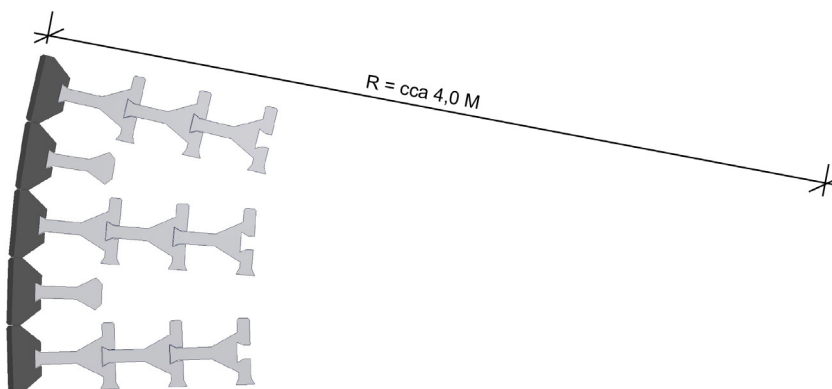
Minimální poloměr vypouklé opěrné zdi
